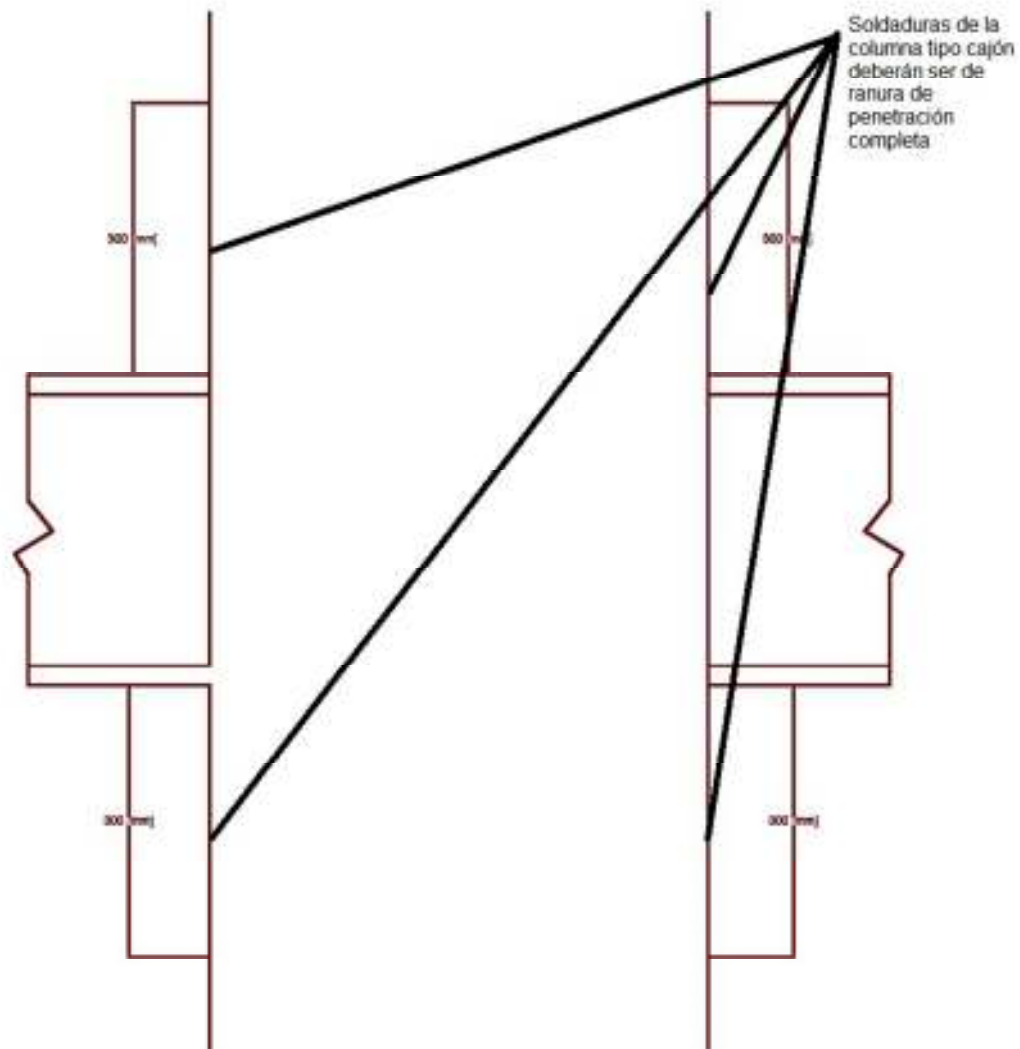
Ubicación de soldadura de ranura tipo penetración completa en la fabricación de columnas
